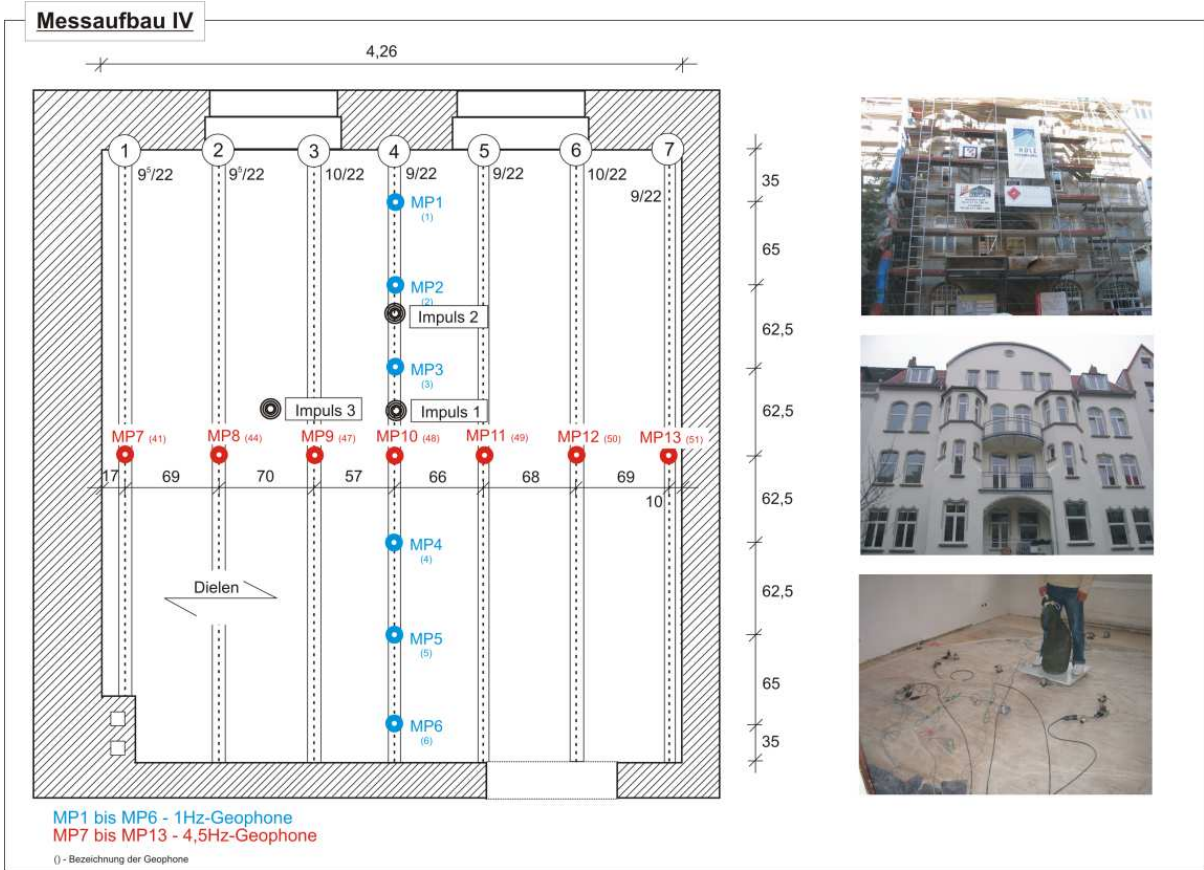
Messaufbau – Messung einer Holzbalkendecke in einem Mehrfamilienhaus
